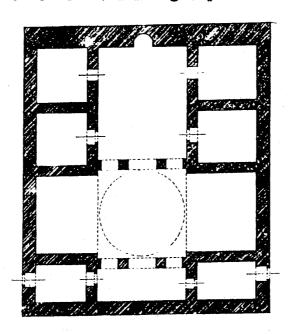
مسقط أفقي لجامع عثمان باشا (١) ضمن مجمعة بحلب (عن : سوفاجيه) .
